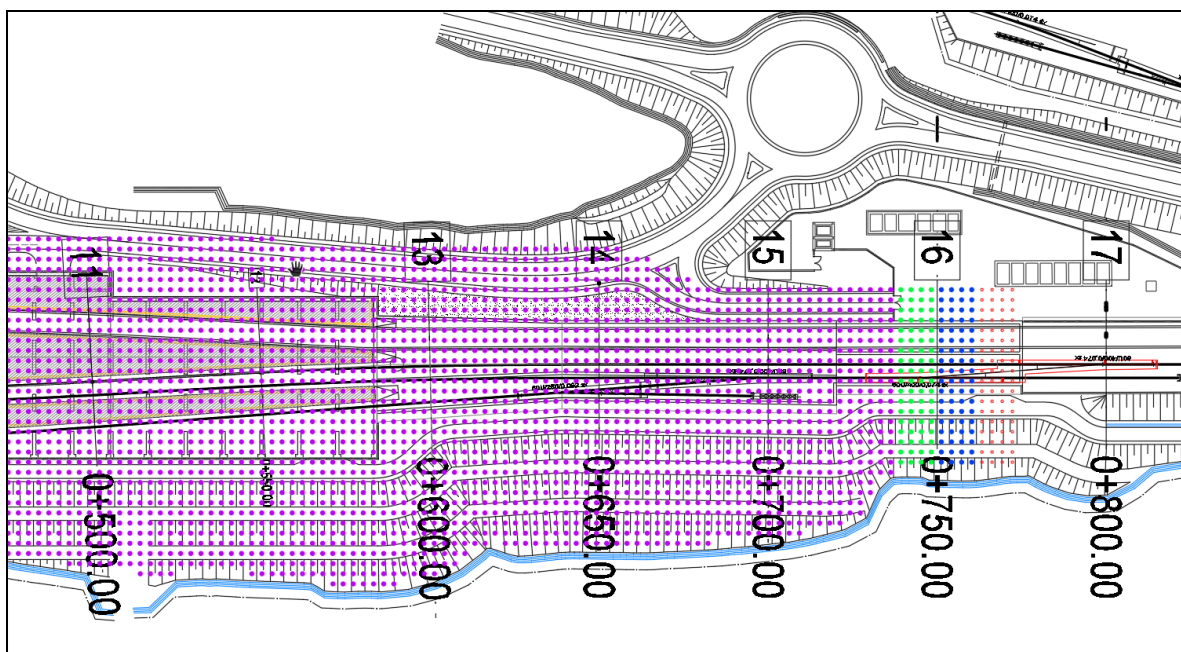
Porzione planimetrica implementata nel modello tridimensionale
